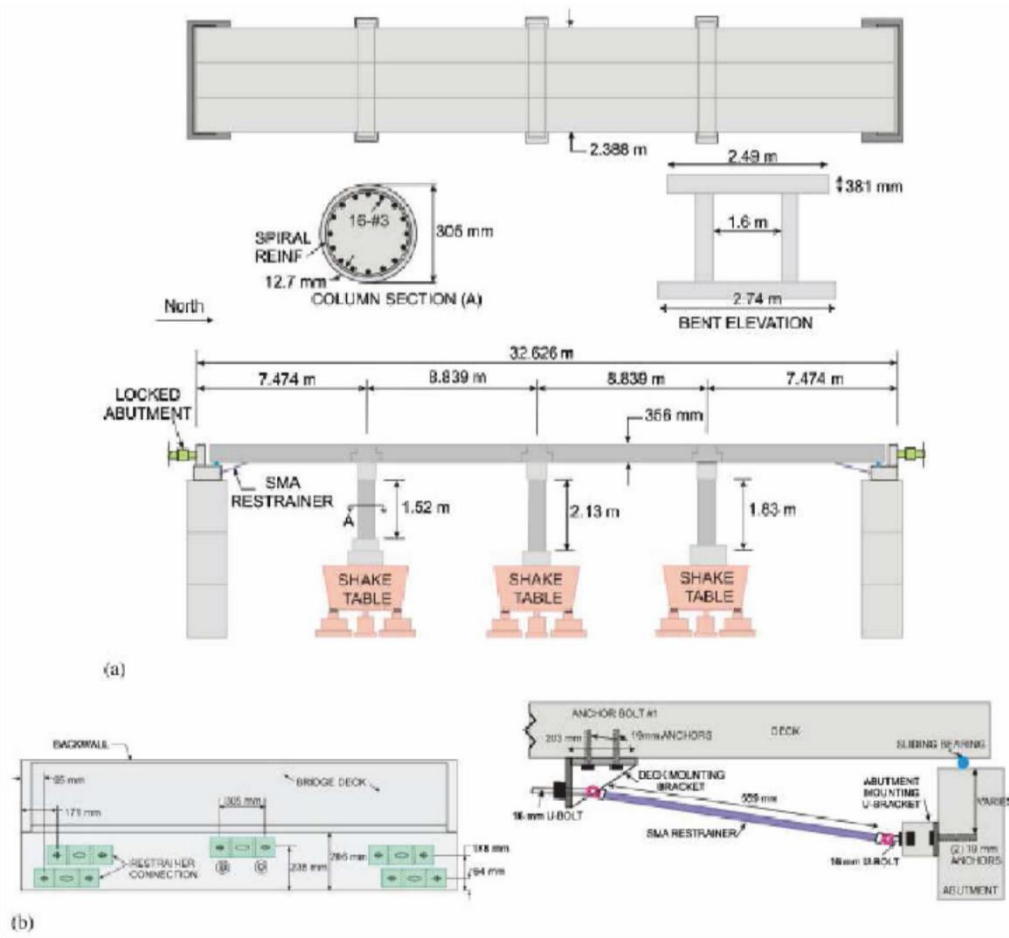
Schéma de configuration de l'essai et du câble de retenue AMF (Padgett et al, 2009).
